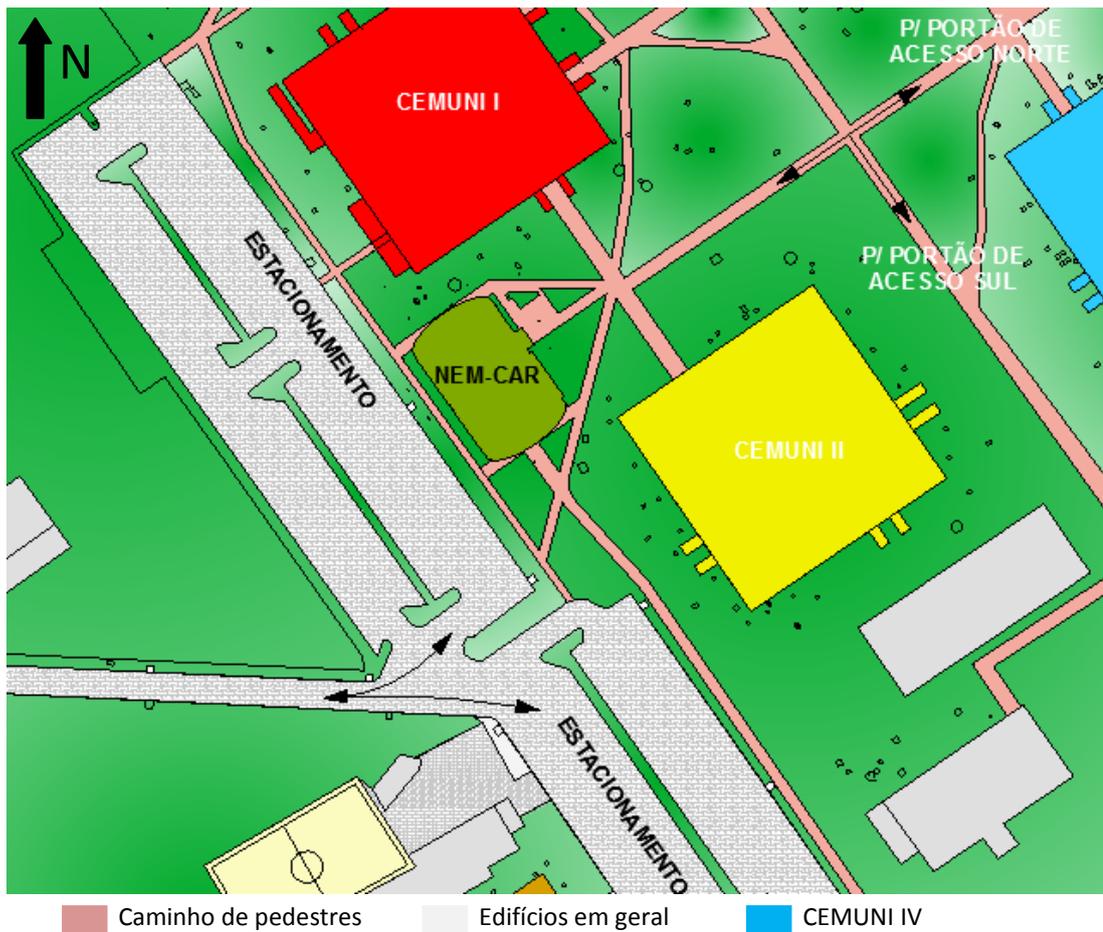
Planta esquemática de implantação do NEM-CAR.
